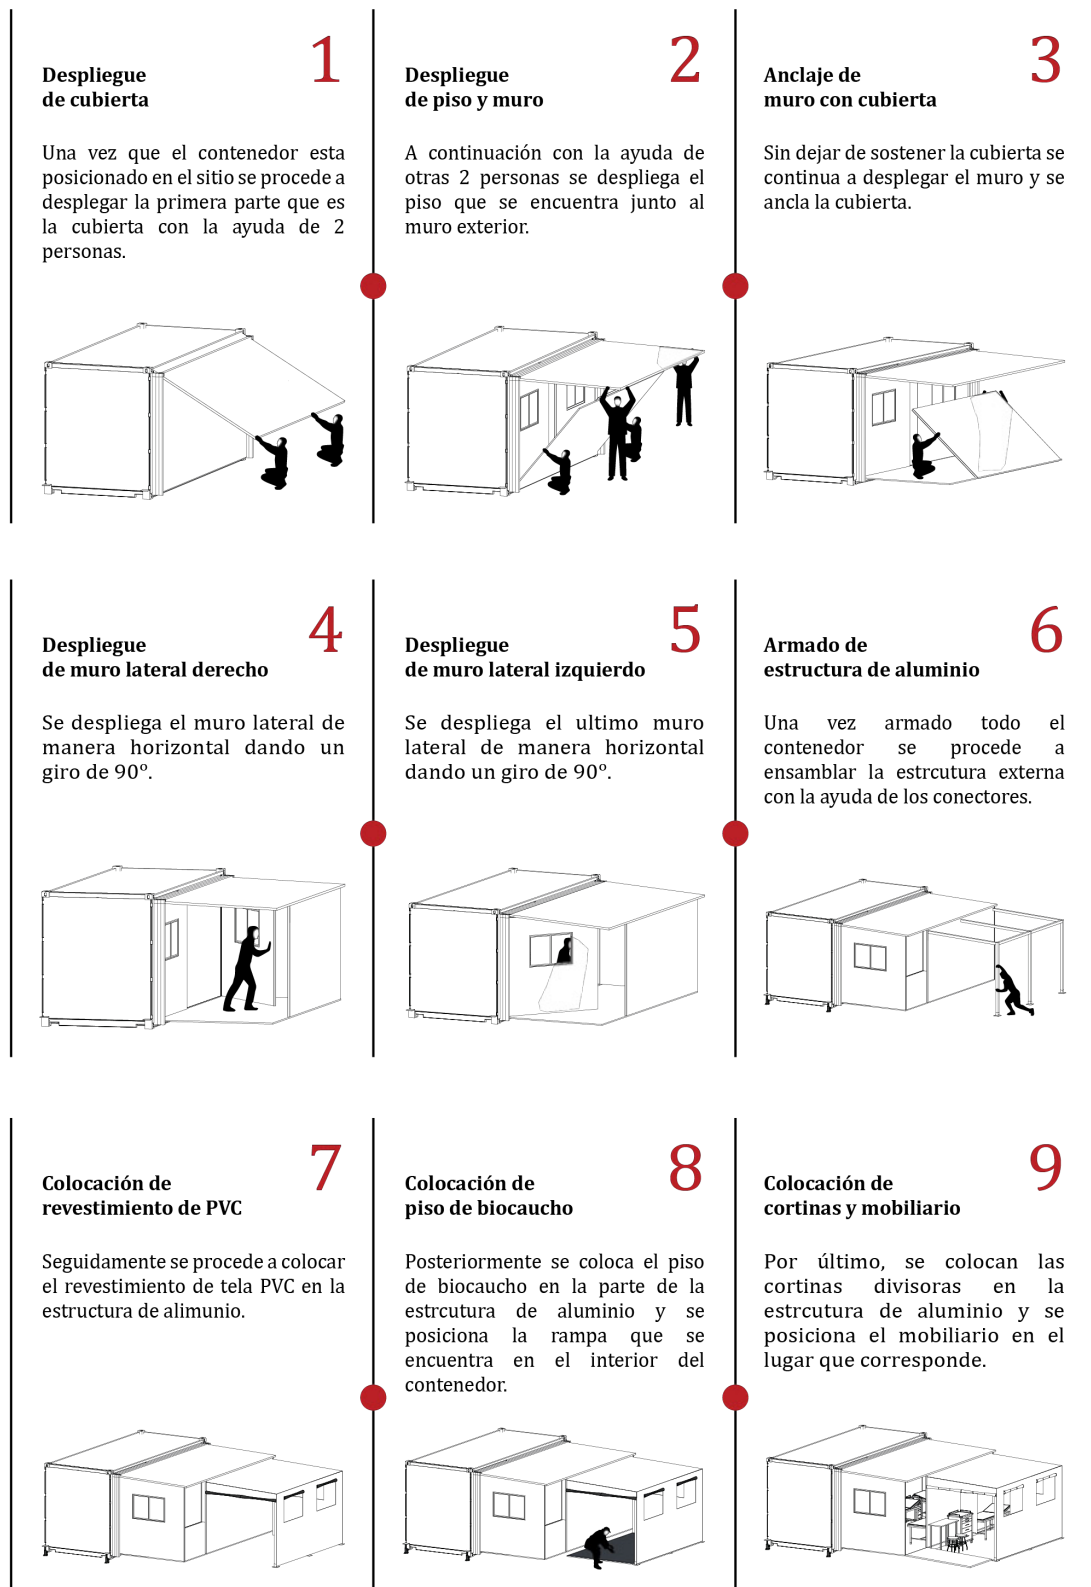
Montaje del habitáculo Emergency Expa Room. Fuente y elaboración: Autores.
